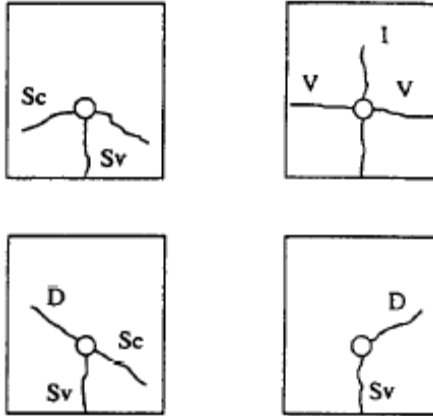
Patrón de grietas particular debido a corrosión del acero de refuerzo identificado en pruebas de laboratorio
